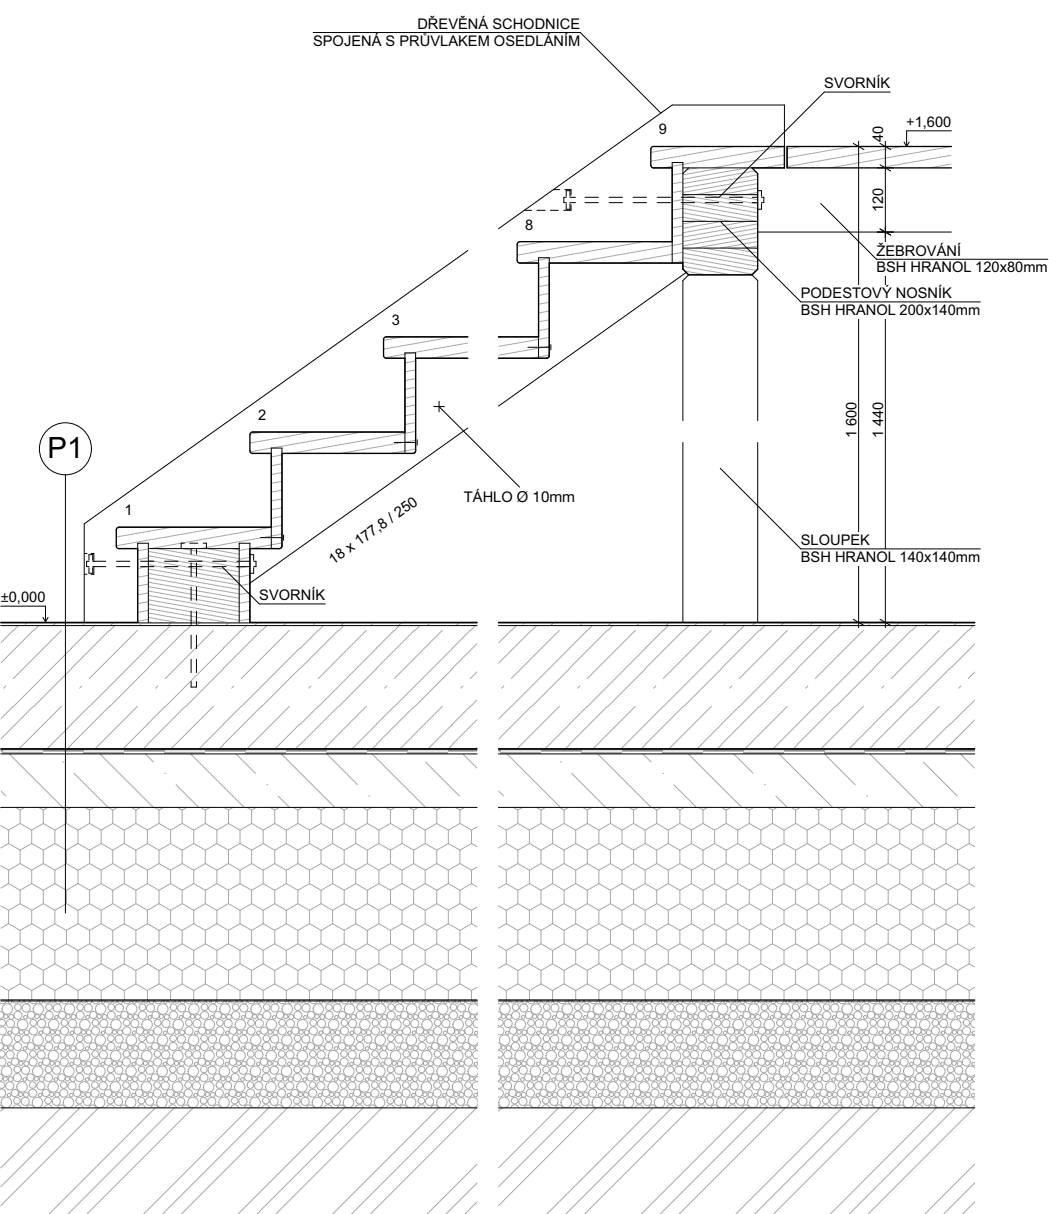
DETAIL ULOŽENÍ SCHODIŠTĚ VE 2.NP M1:10
